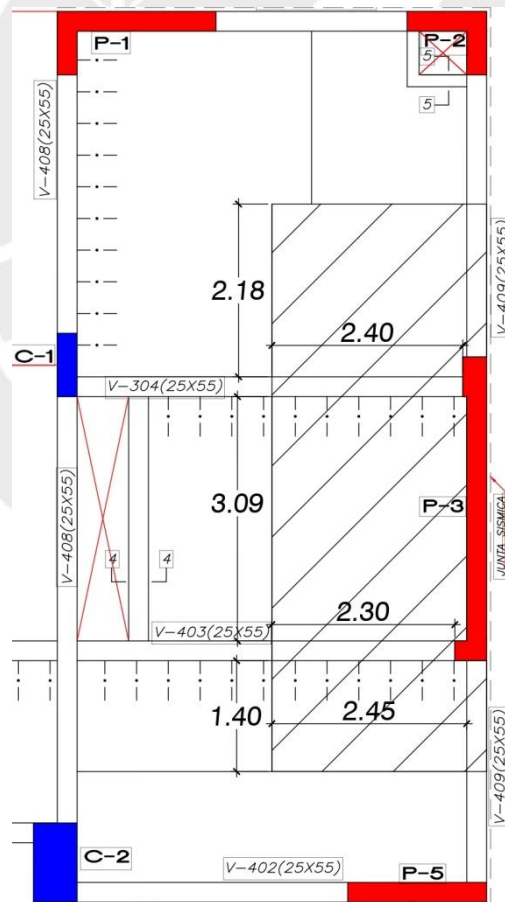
Planta de área tributaria de la placa P-3 de la azotea
